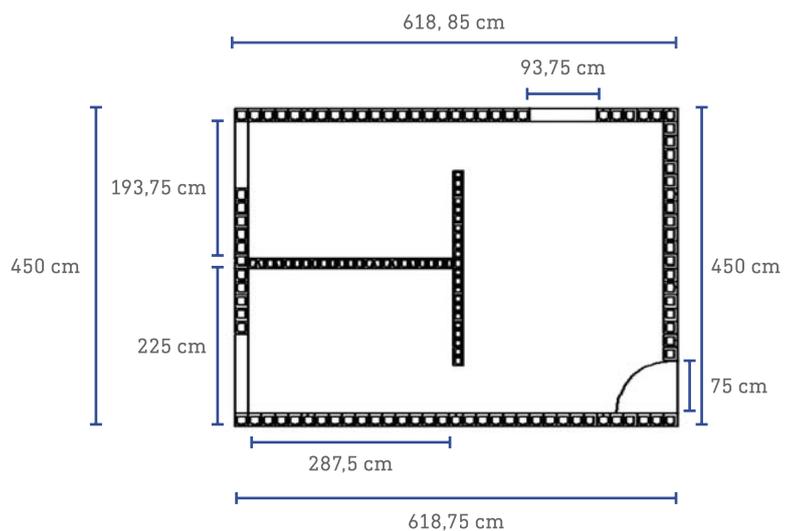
• Modulación en planta horizontal para menor desperdicio.
